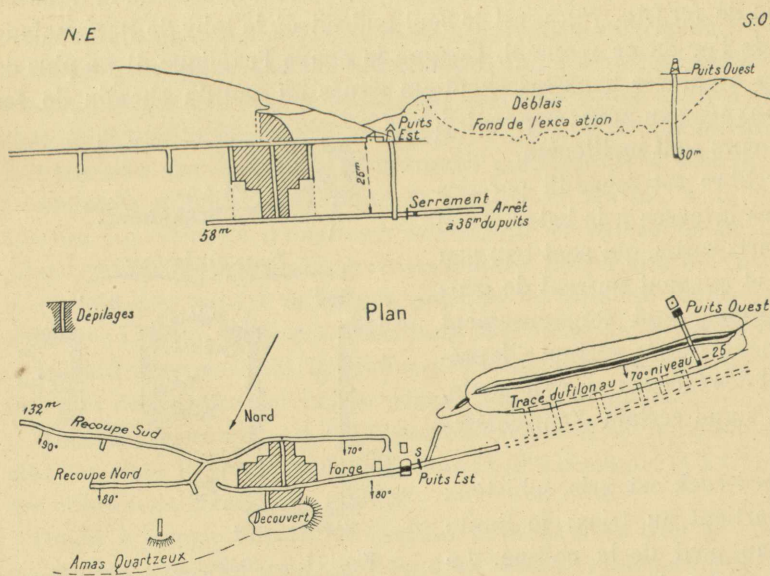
Plan et coupe des travaux souterrains de Ranomafano.
